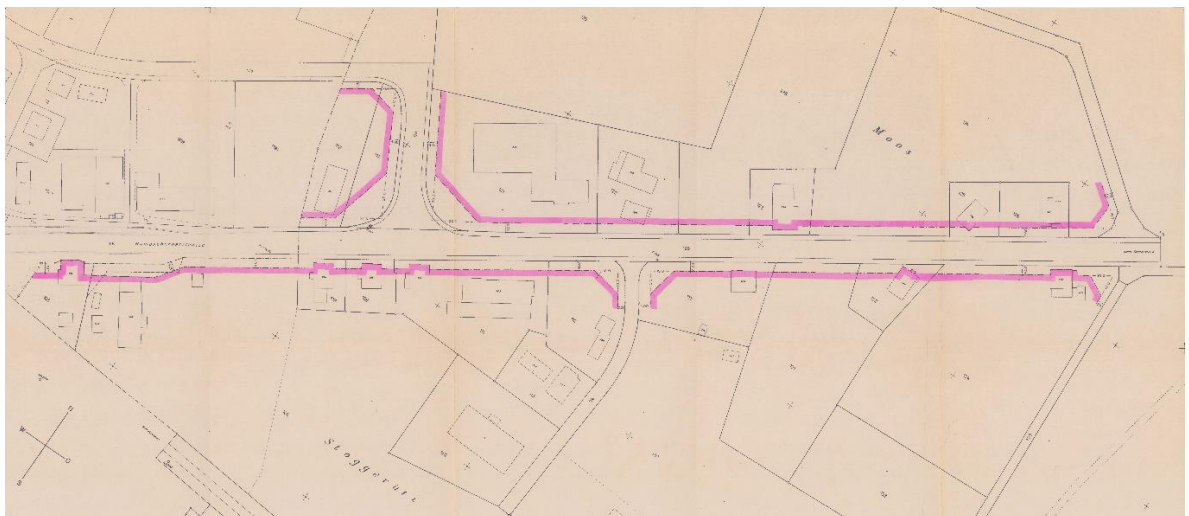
Ausschnitt Baulinienplan längs Staatstrasse Moos
